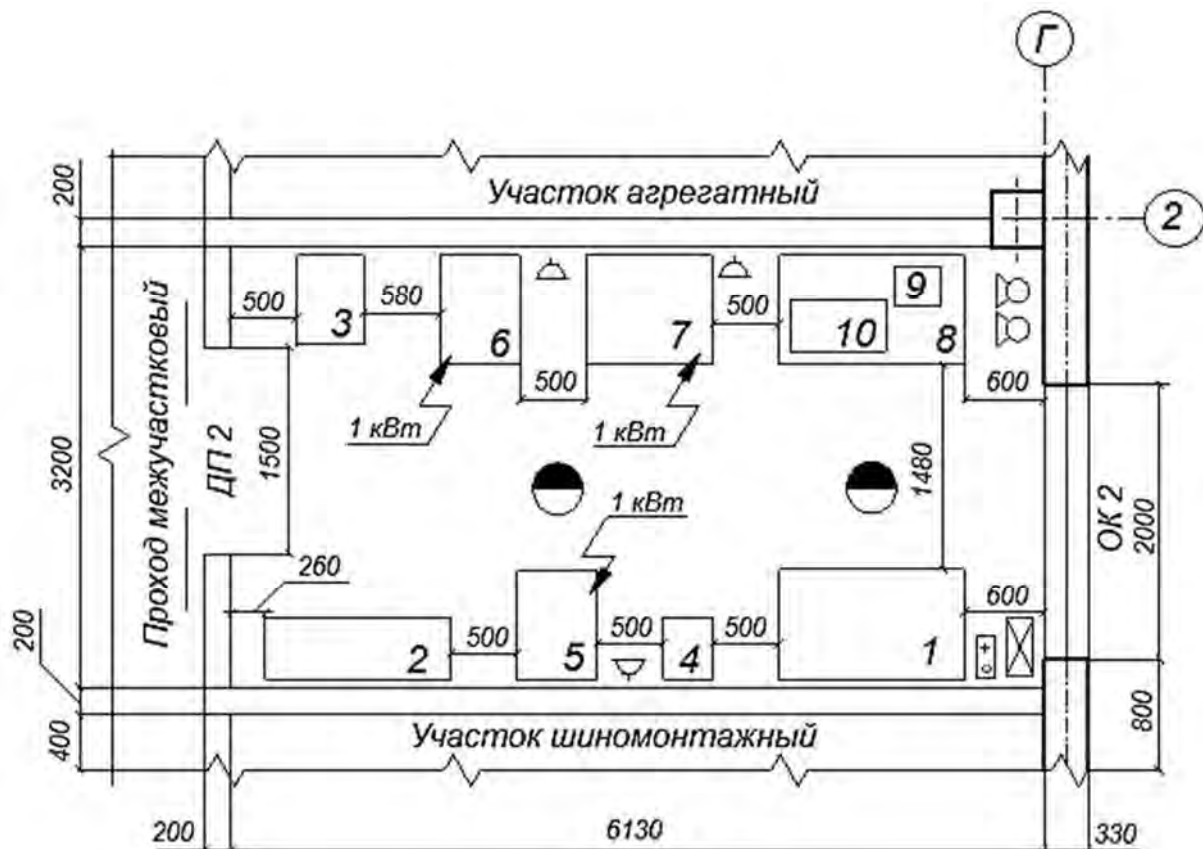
Планировочное решение электротехнического участка: 1 — верстак; 2 — стеллаж; 3 — ванна для мойки; 4 — ларь; 5 — заточной станок; 6 — сверлильный станок; 7 — контрольно-испытательный стенд; 8 — стол; 9, 10 — приборы для проверки элементов системы зажигания и др.
